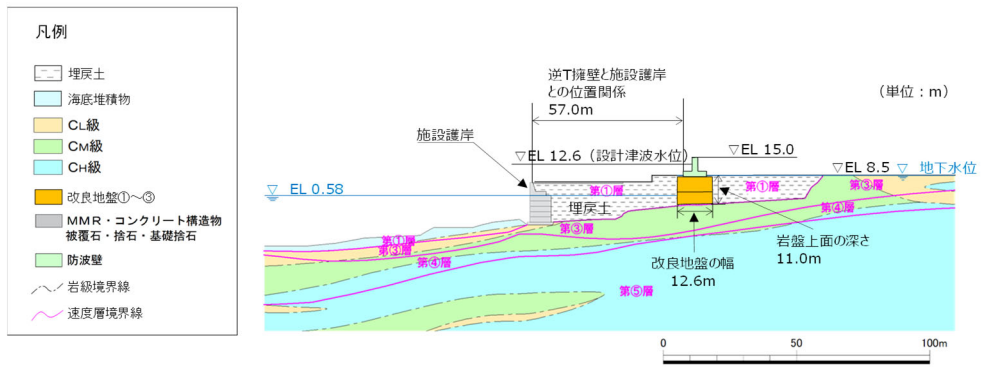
防波壁（逆 T 擁壁）の横断面図（⑥-⑥断面）
